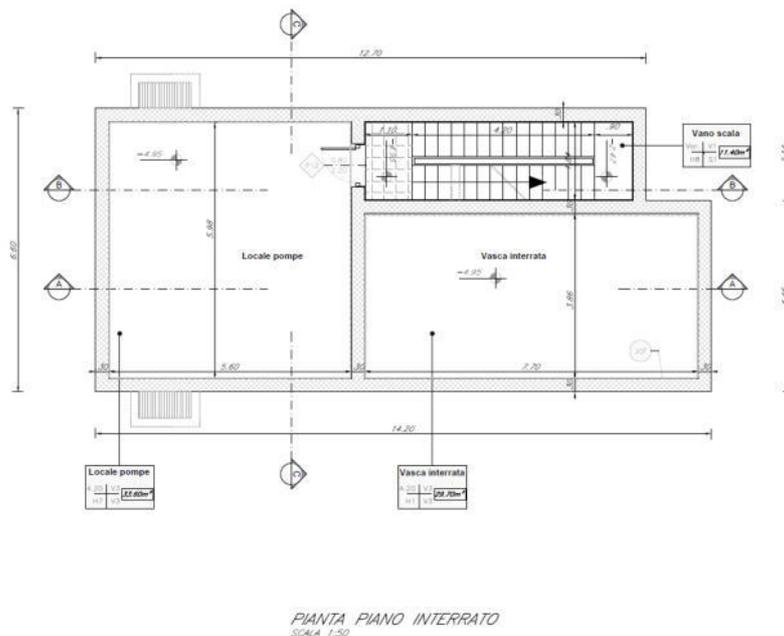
Pianta piano interrato locale di pressurizzazione e impianto antincendio - E1 (FA-B)
